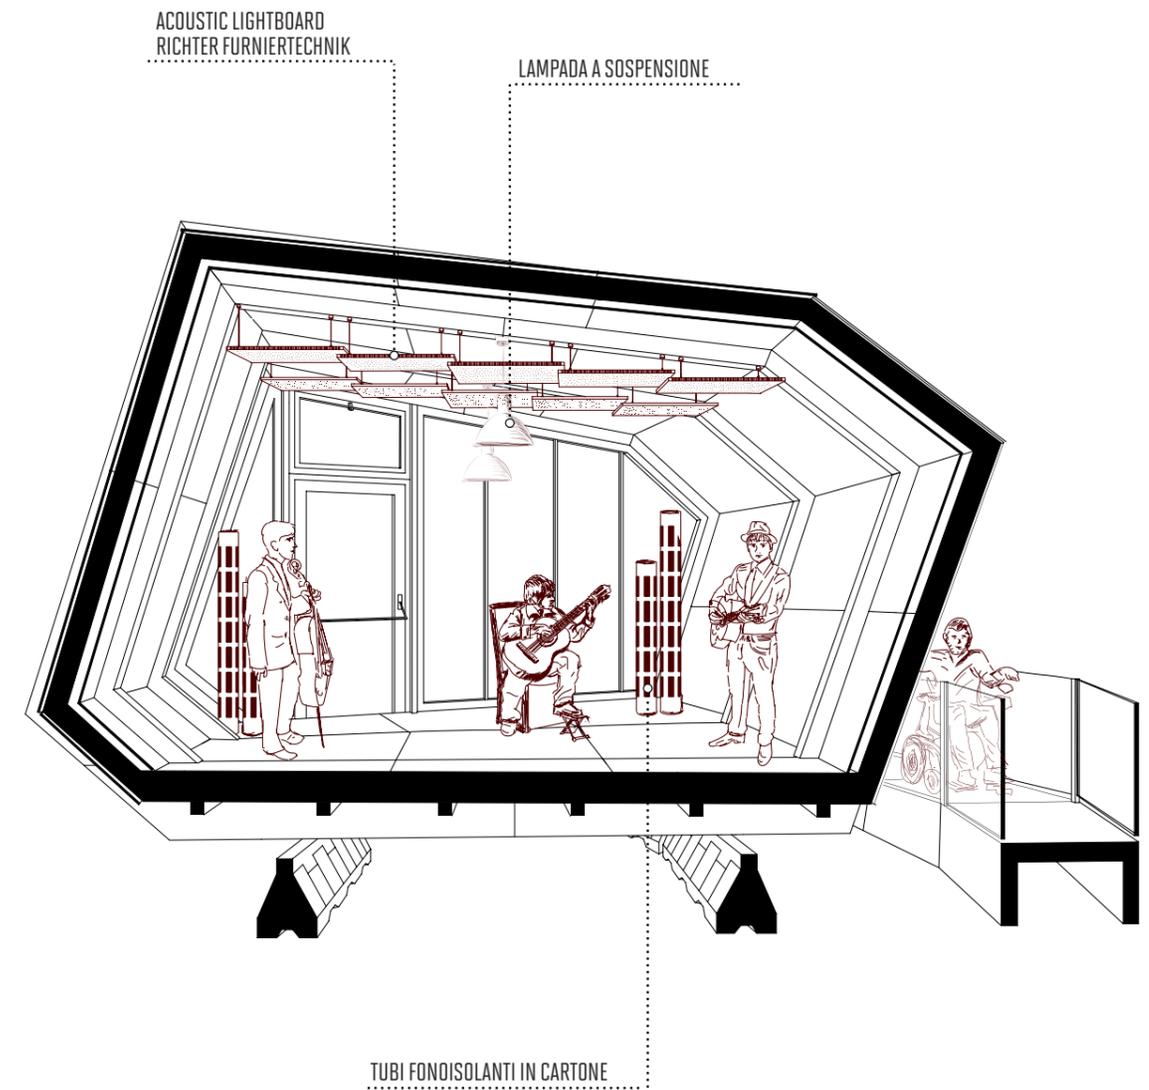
SEZIONE PROSPETTICA DEL BOX
